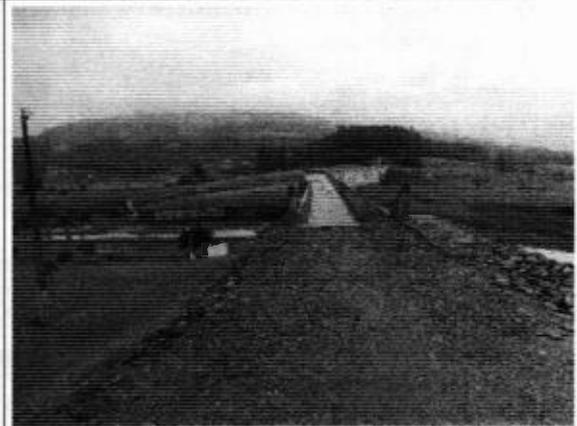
Vista geral da ombreira, lado esquerdo (olhando-se para jusante).
